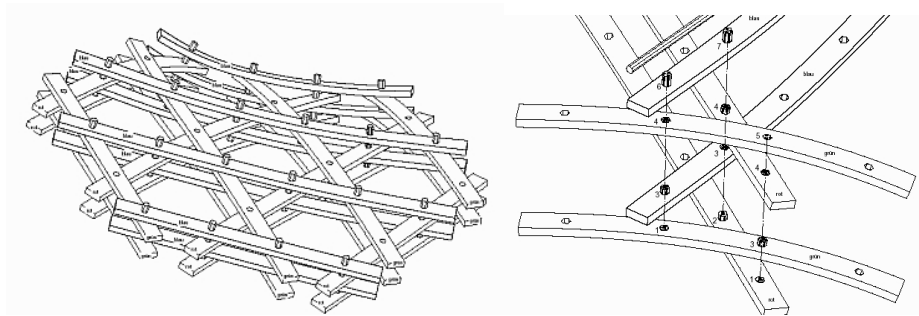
Yapı Üç Boyutlu Modeli, Shigeru Ban Architects, Jean De Gastines
